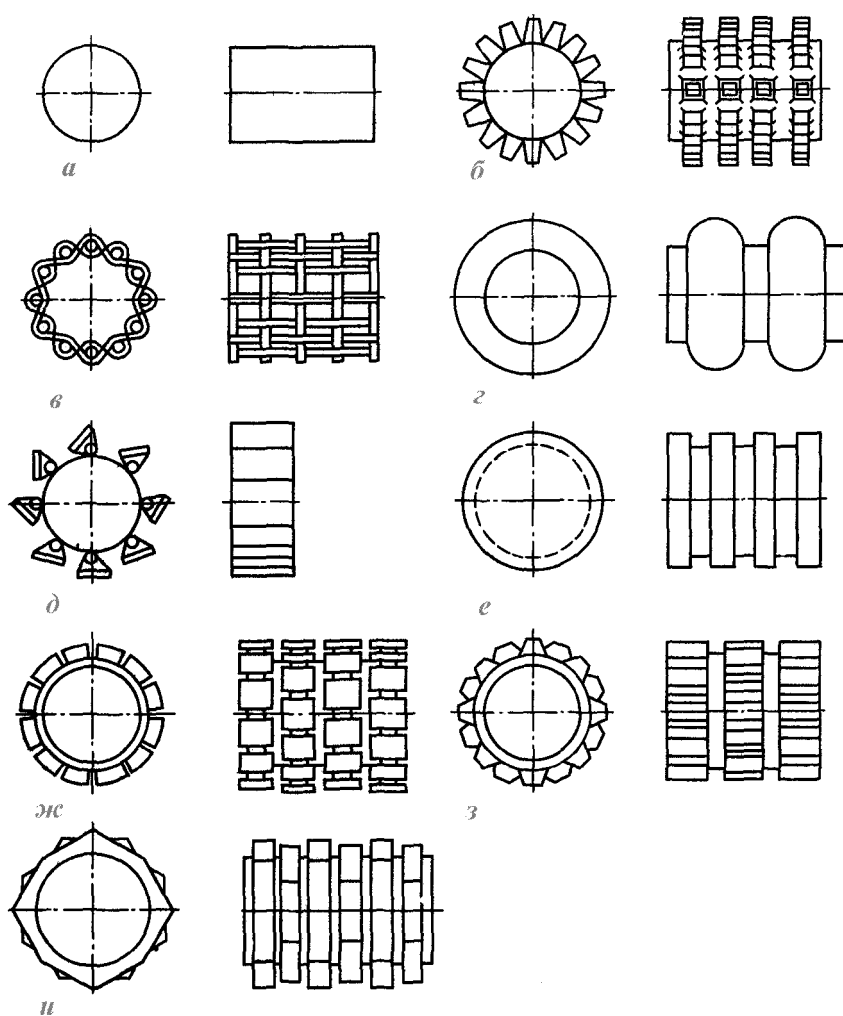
Схемы укатывающих рабочих органов: *a* – гладкобарабанный; *б* – кулачковый; *в* – решетчатый; *г* – пневмоколесный; *д* – с плитками, шарнирно присоединенными к ободу колеса; *е* – дисковый; *ж* – сегментный; *з* – копмакторный валец; *и* – валец с набором многоугольных дисков
